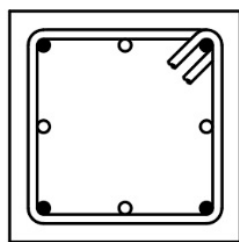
Armadura probeta piloto de hormigón armado 210 kg/cm²
